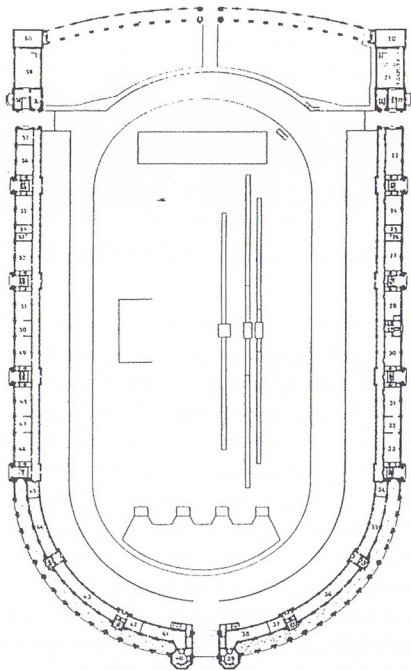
Stockholms stadion, plan över byggnad och innerplan.
